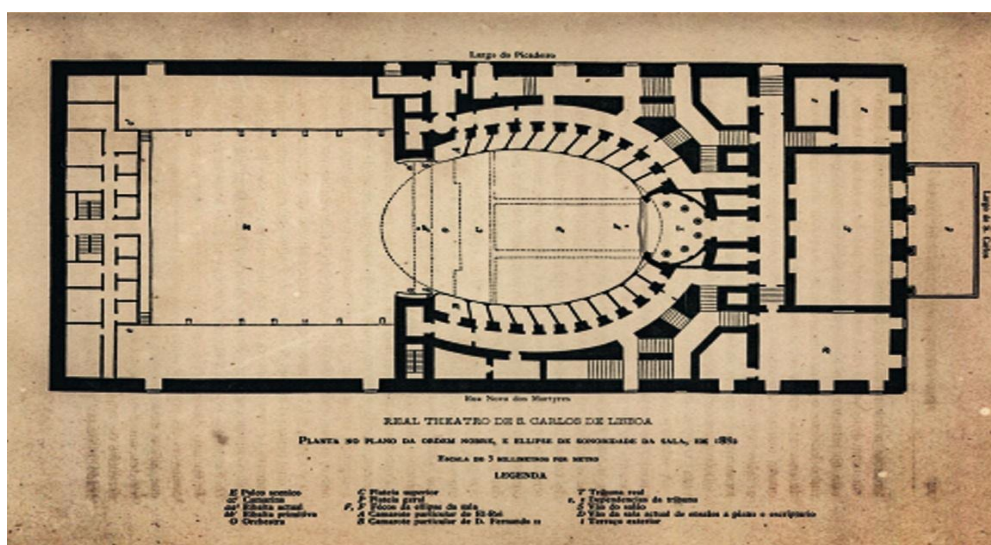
Planta-baixa do Real Teatro de São Carlos
